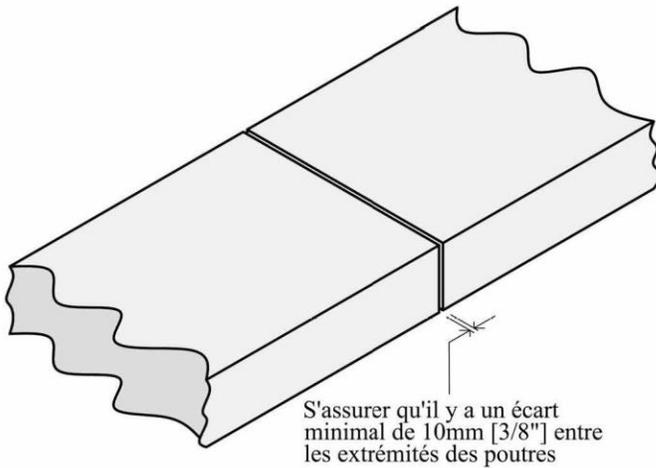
(iii) : Poutre au sol pour stèles multiples.
